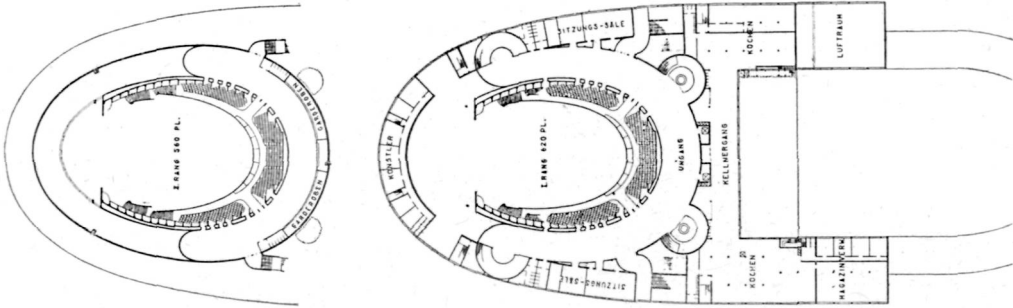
Kongreßhalle der Berliner Ausstellungenanlagen, Galeriegeschosse¹⁾
